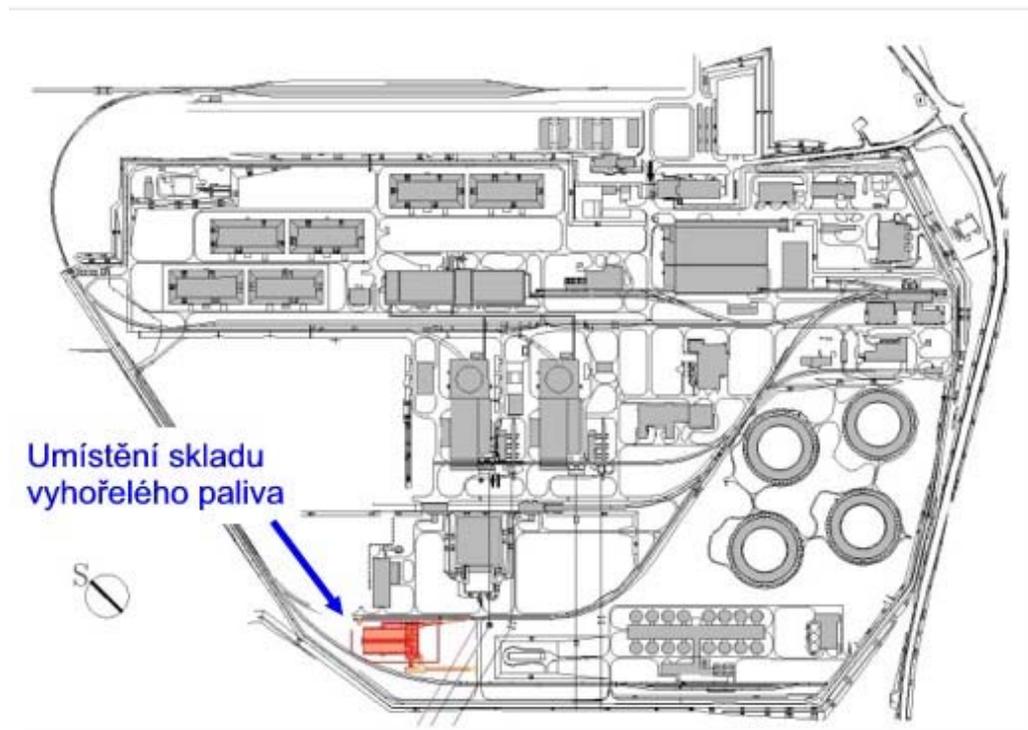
Detail der Lage des Zwischenlagers für abgebrannte Brennstäbe Temelín im Verbauungsplan des Kraftwerks.
